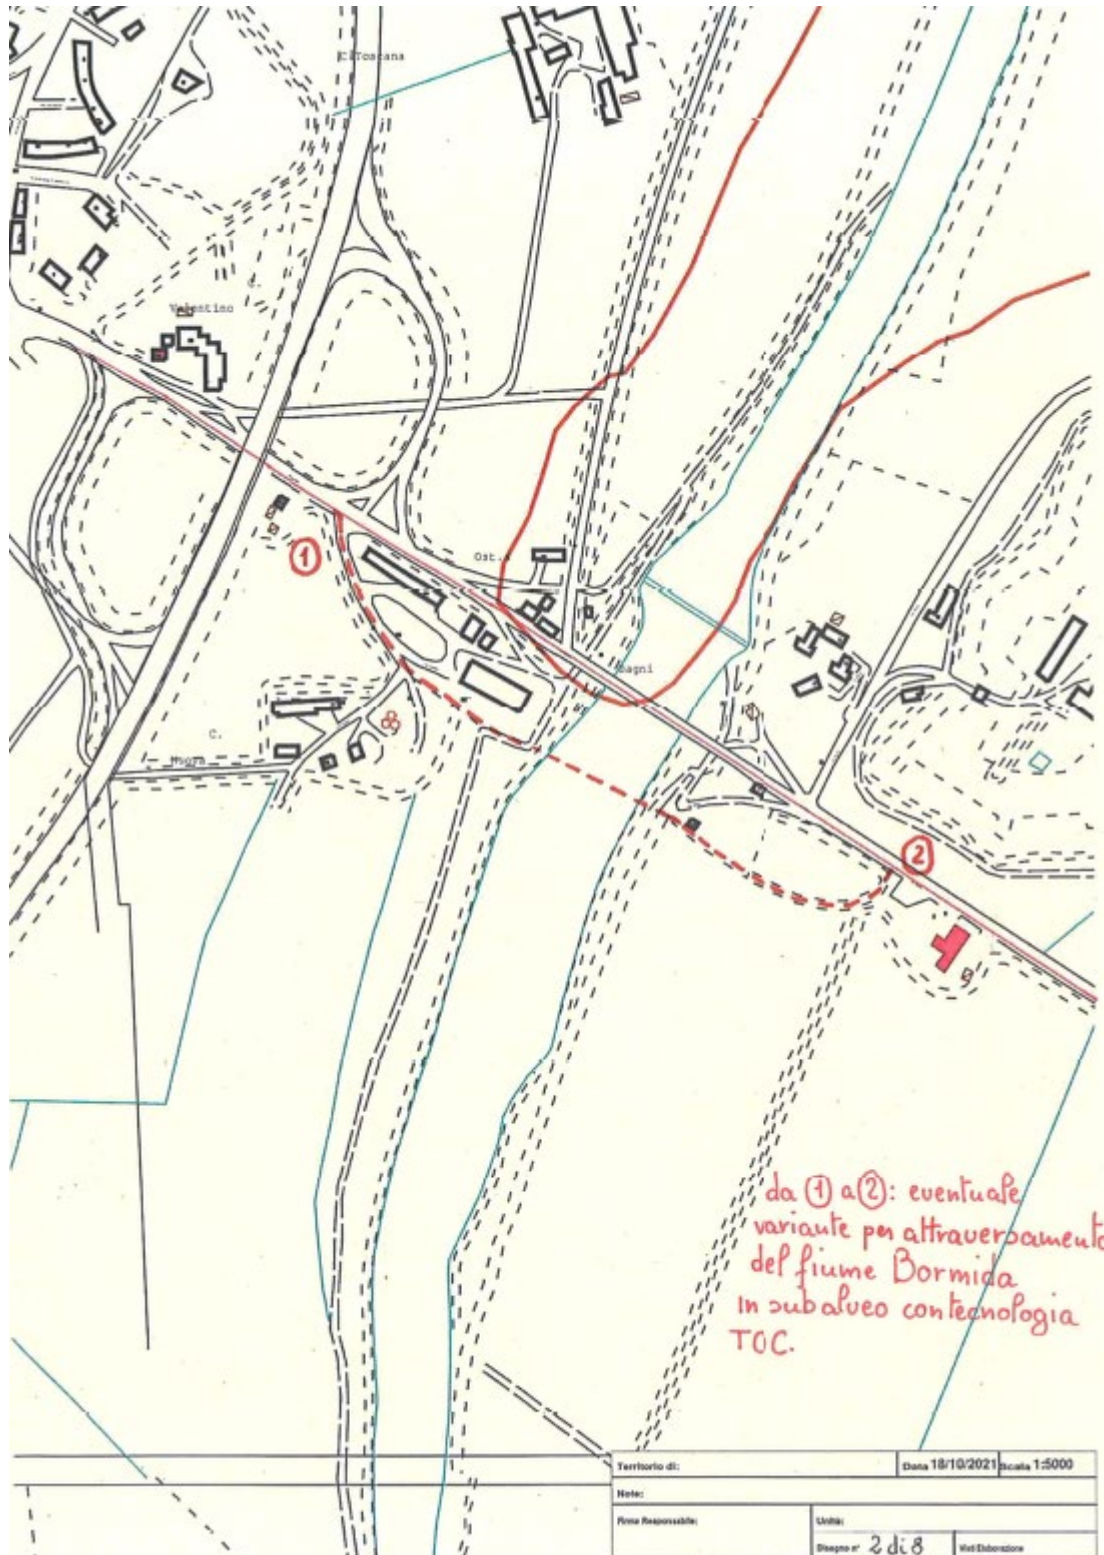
Tracciato alternativo cavidotti di connessione per attraversamento in subalveo del fiume Bormida secondo planimetrie STMG
